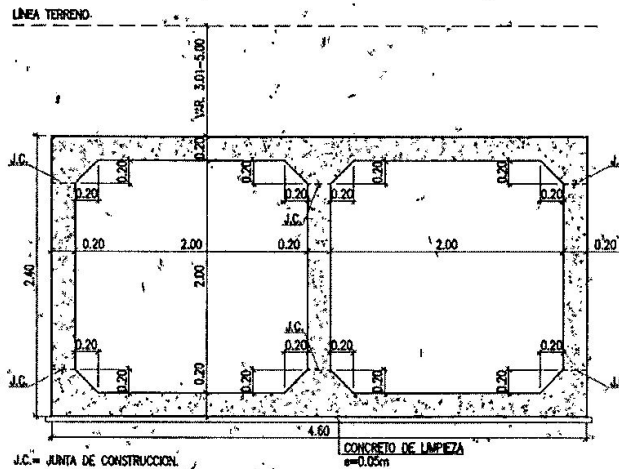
Sección transversal de la ALCANTARILLA TIPO CAJON DOBLE (2x2m – 3m < H <= 5m).
